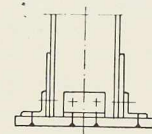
Détails constructifs. Assemblages rivés et soudés.
